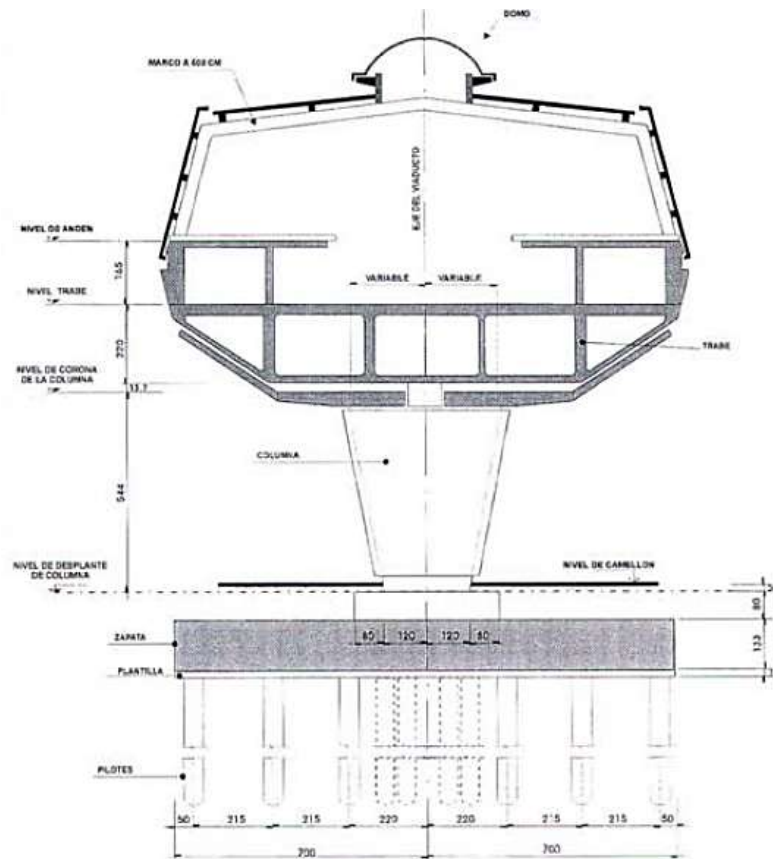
Estructura en tramo. Fuente: Grupo ICA, 1997.
